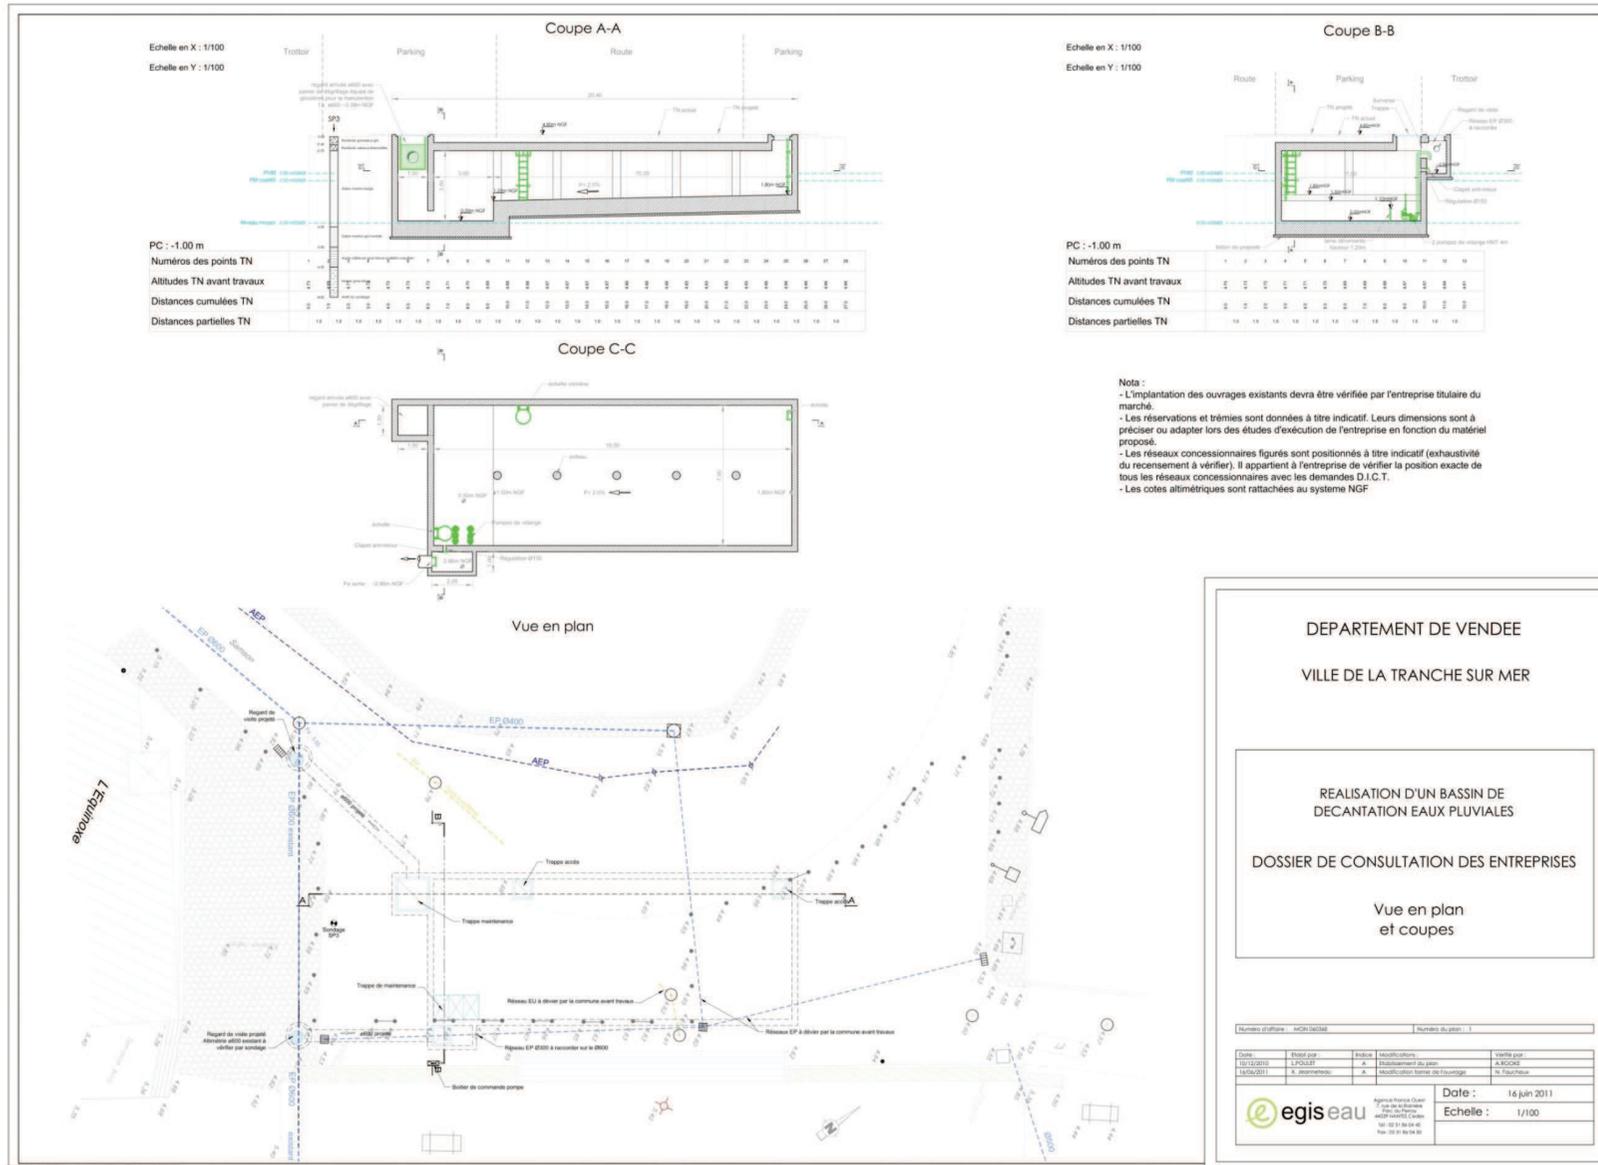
Plan du bassin de décantation des eaux pluviales du Belvédère
